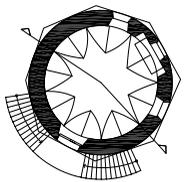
Grundriss Albrecht/Austerhuber/Gallob 2008. M 1:400.
